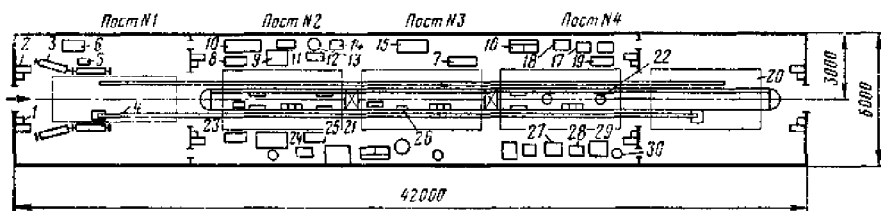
Схема технологической планировки поточной линии ТО-2: 1 – механизм привода ворот; 2 – установка для тепловой завесы ворот; 3 – направляющие ролики; 4 – конвейер для передвижения грузовых автомобилей; 5 – установка для отсоса отработавших газов; 6 – тележка для транспортировки аккумуляторных батарей; 7 – пост электрика-топливщика; 8 – электрогайковерты для гаек колес грузовых автомобилей; 9 – тележка для снятия и установки колес; 10 – слесарный версток; 11 – воздухораздаточная колонка; 12 – посты слесаря-авторемонтника; 13 – стеллаж-вертушка для крепежных деталей; 14 – бак для тормозной жидкости; 15 – стол для оформления и хранения учетной документации; 16 – лари для обтирочных материалов; 17 — маслораздаточные колонки; 18 – маслораздаточные баки; 19 – пост смазчика-заправщика; 20 – направляющий желоб для переднего колеса; 21 – переходные мостики; 22 – шарнирные воронки для слива отработавших масел; 23 – подставки для работы в осмотровой канаве; 24 – ящики для инструмента и крепежных деталей; 25 – подъемники канавные; 26 – электрогайковерт для гаек стремянок рессор (канавный); 27 – установка для заправки агрегатов трансмиссионным маслом; 28 – передвижной нагнетатель смазки с электроприводом; 29 – стол-ванна для промывки воздушных фильтров; 30 – подвод сжатого воздуха
